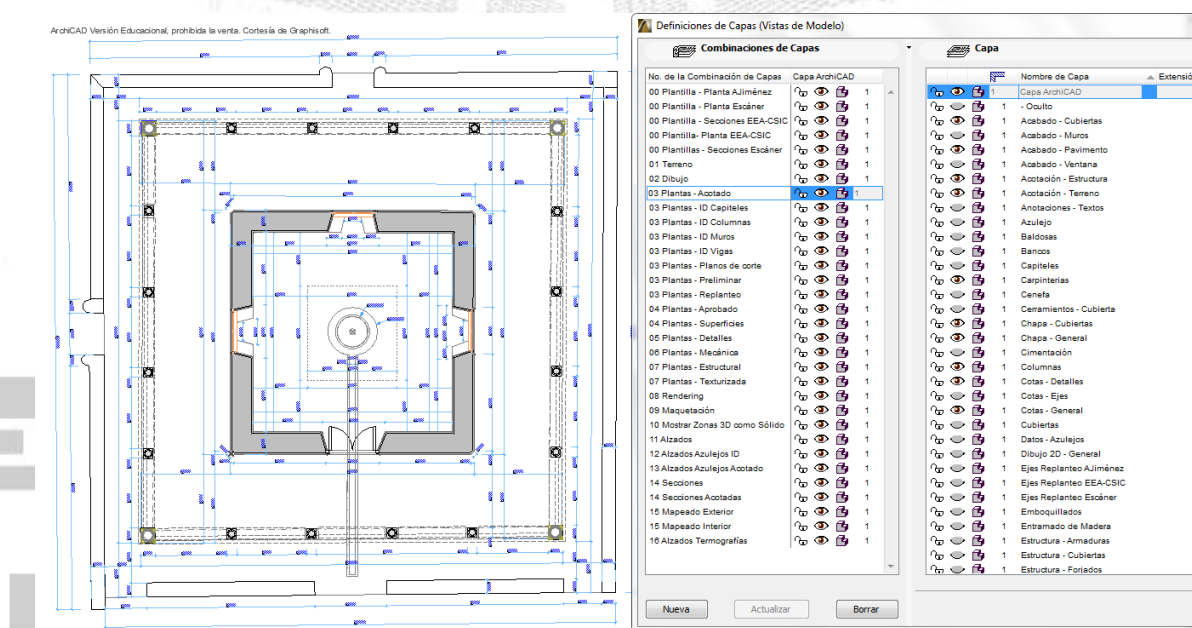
Vista Planta Baja Acotada +1,50 filtrada con la combinación de capas 03 Plantas – Acotado.
